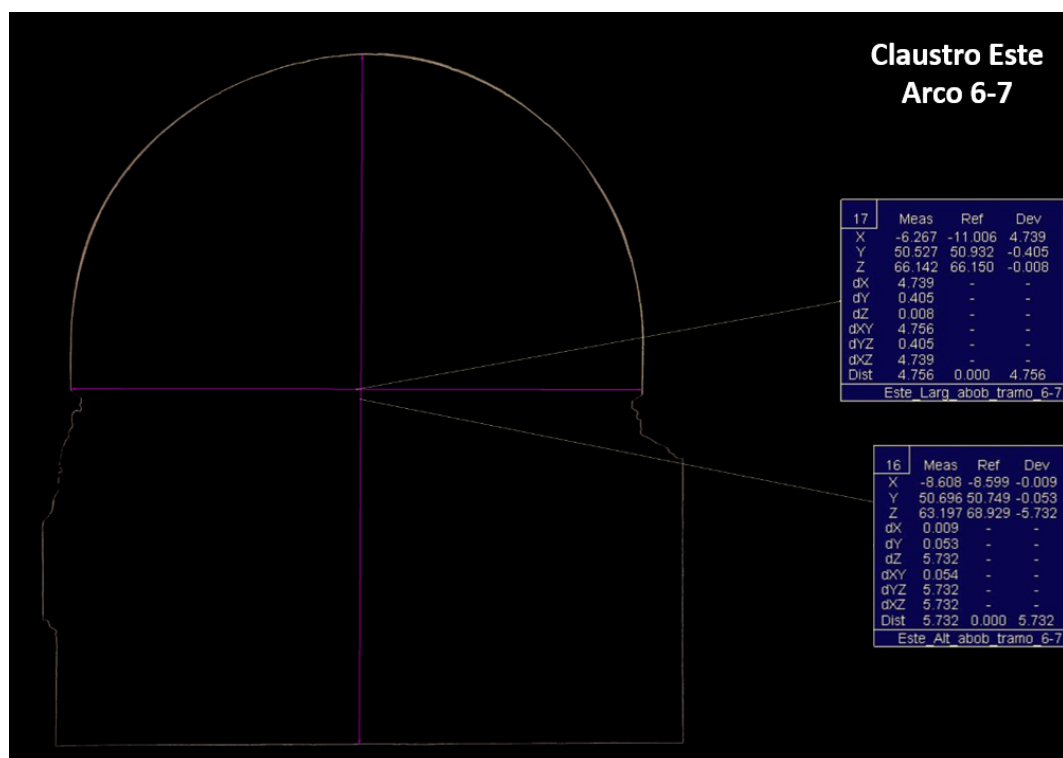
Corte transversal do Arco 6-7 do claustro Este de D. Dinis.
